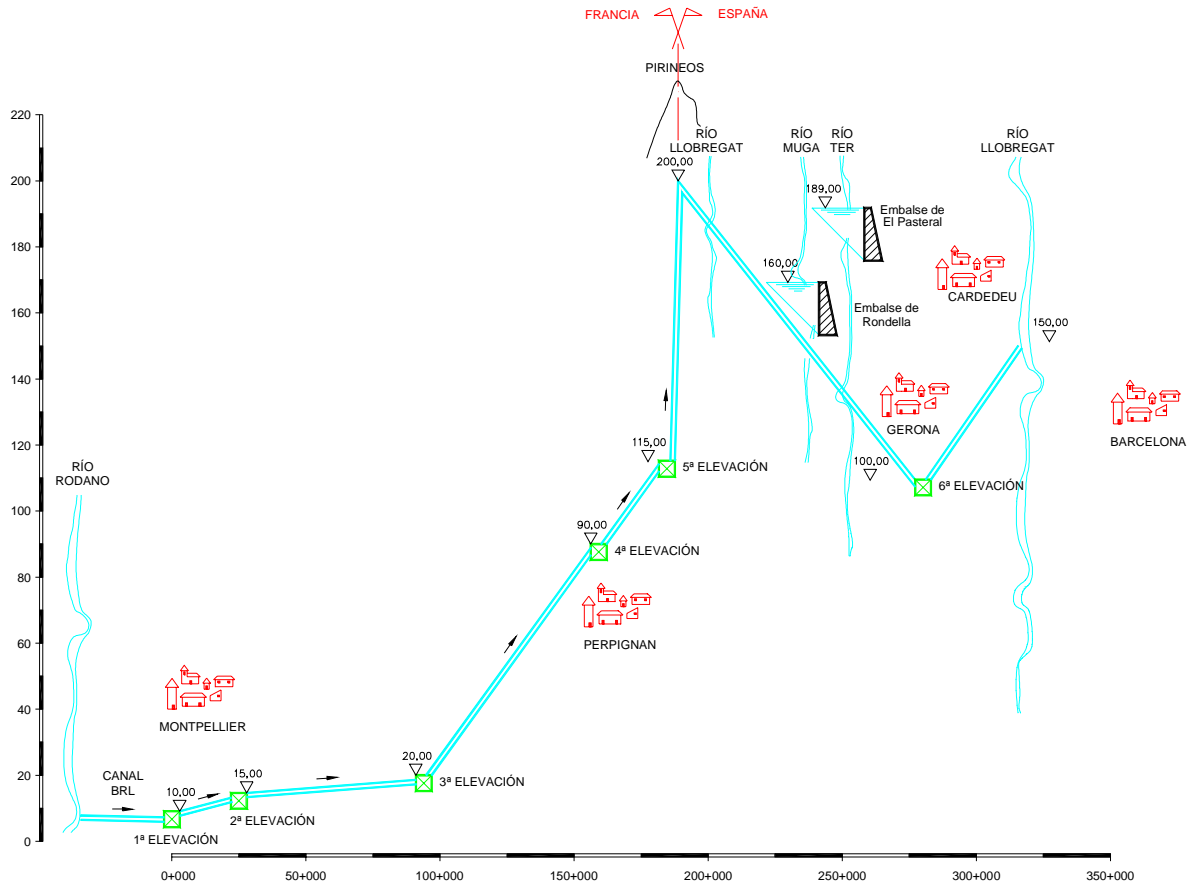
Conducción Ródano – Barcelona. Esquema en alzado
